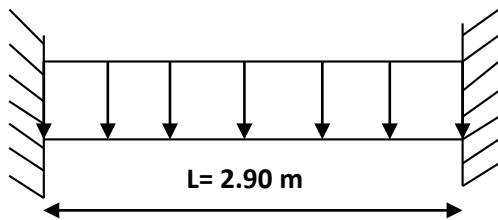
Schéma statique de la poutre palière.
